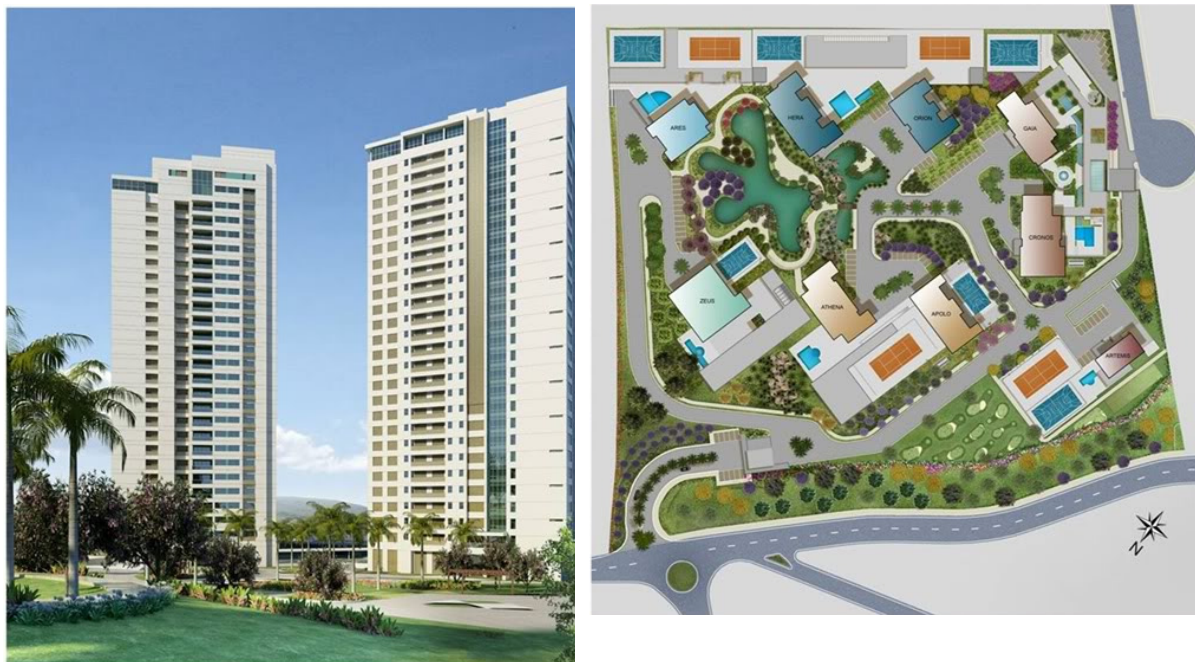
Empreendimento da construtora Lider localizado no bairro Vila da Serra
